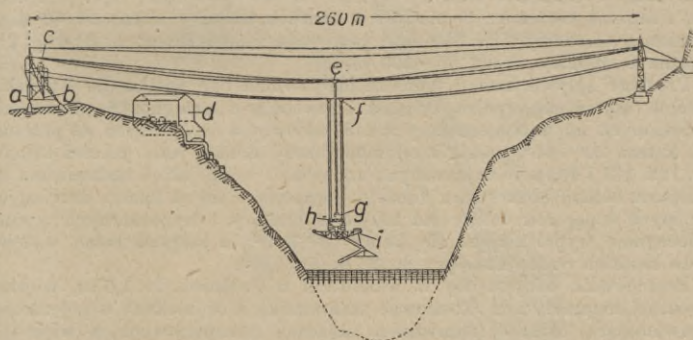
a — dźwigarka żórawia linowego, b — mechanizm do przesuwania przyrządu do lania betonu, c — budka maszynisty, d — mieszarki betonu, e — wózek dla żórawia linowego, f — wózek dla przyrządu do lania betonu, g — kubel z ruchomym dnem, h — pomost do obsługi kubła, i — wysięgnica obrotowa z rywną do lania betonu.
